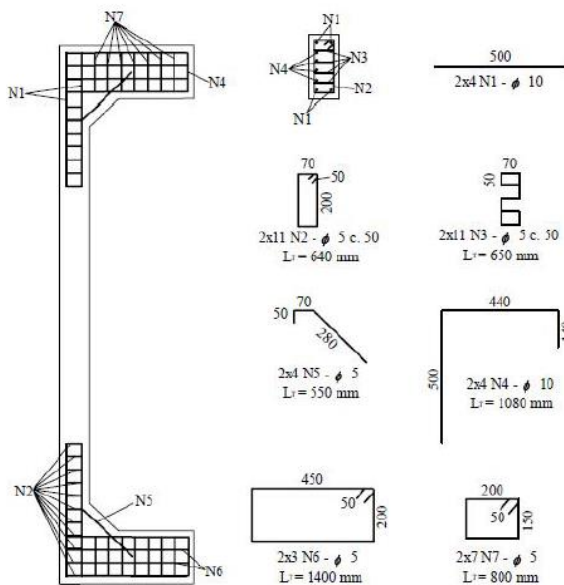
Detalhamento das armaduras da Série PSA (ADORNO, 2004)
